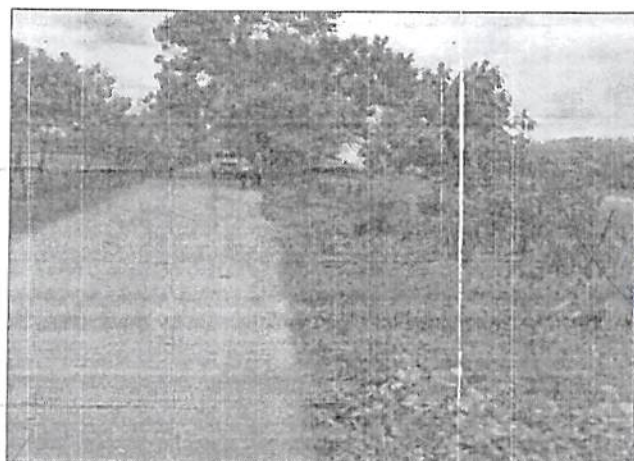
Estrada de piçarra c/ acesso ao terreno do poço.
